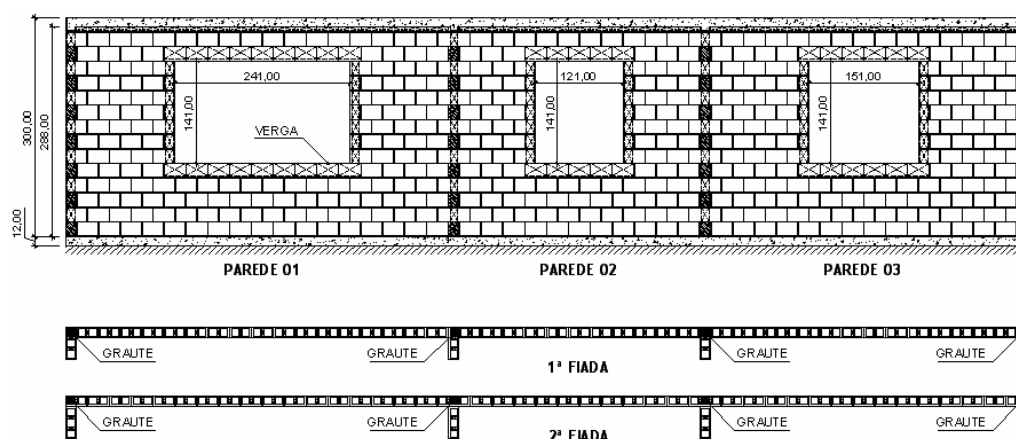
Paredes 01, 02, e 03 – Detalhe da 1ª e 2ª fiadas e elevação.
